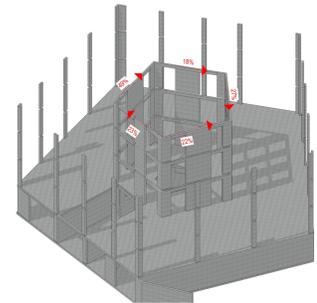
3D-Rohbaumodell mit Aufteilung der horizontalen Lasten (Allplan 2019).
